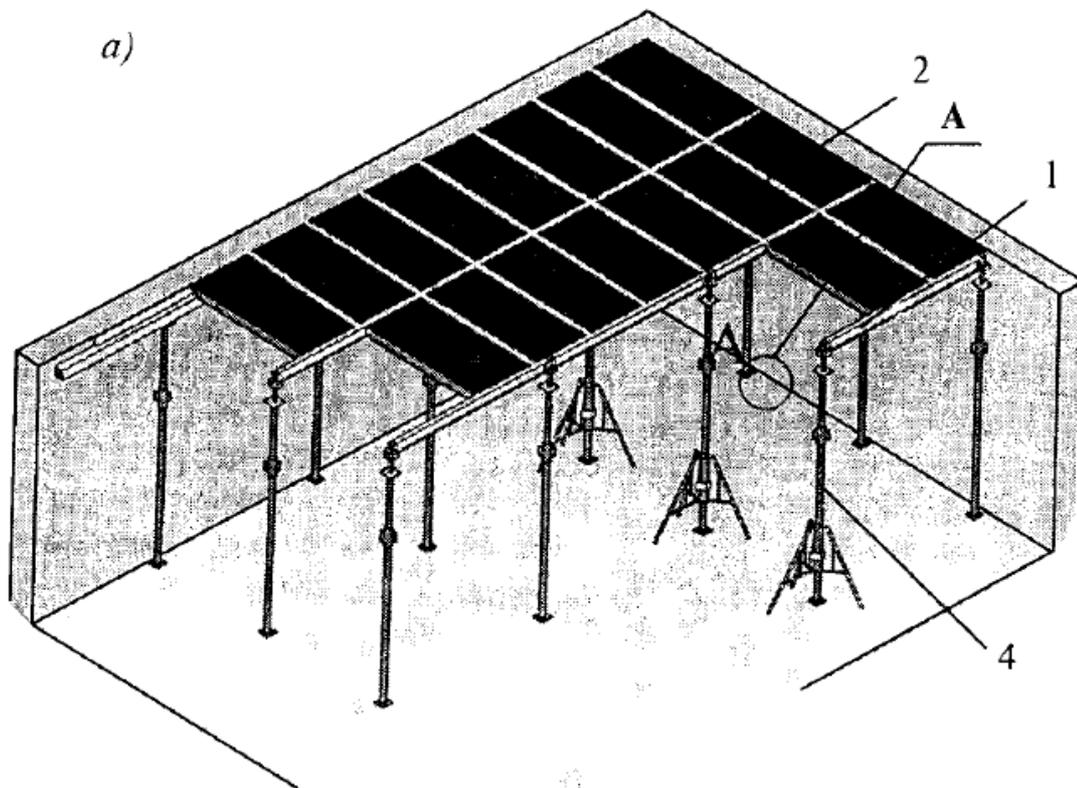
Опалубка перекрытий фирмы «НОЕ» с «падающими» головками:
